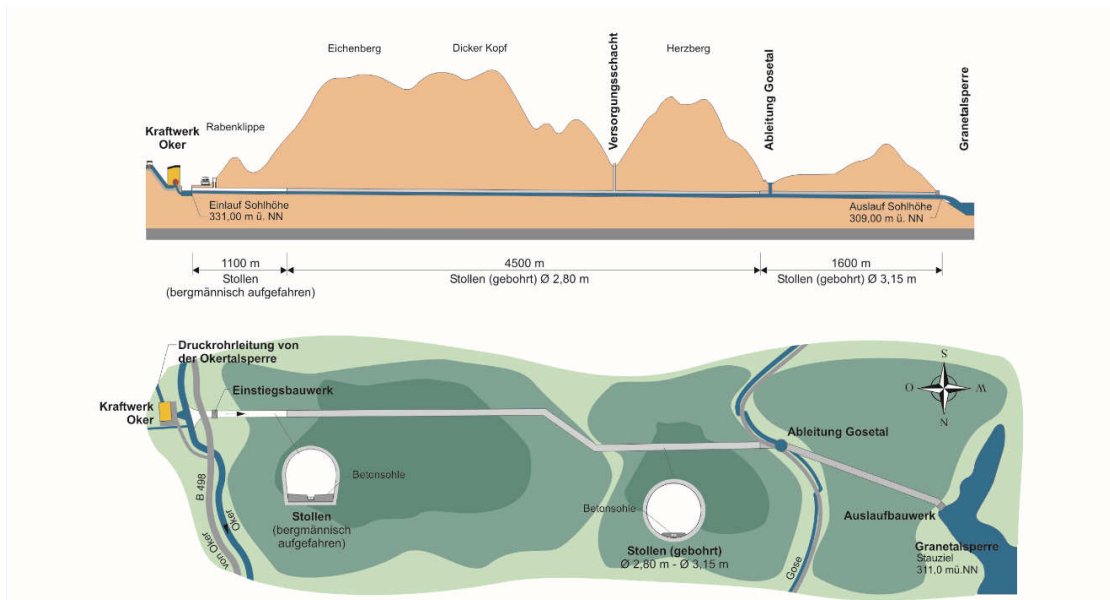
Oker-Grane-Stollen Lageplan und Längsschnitt
